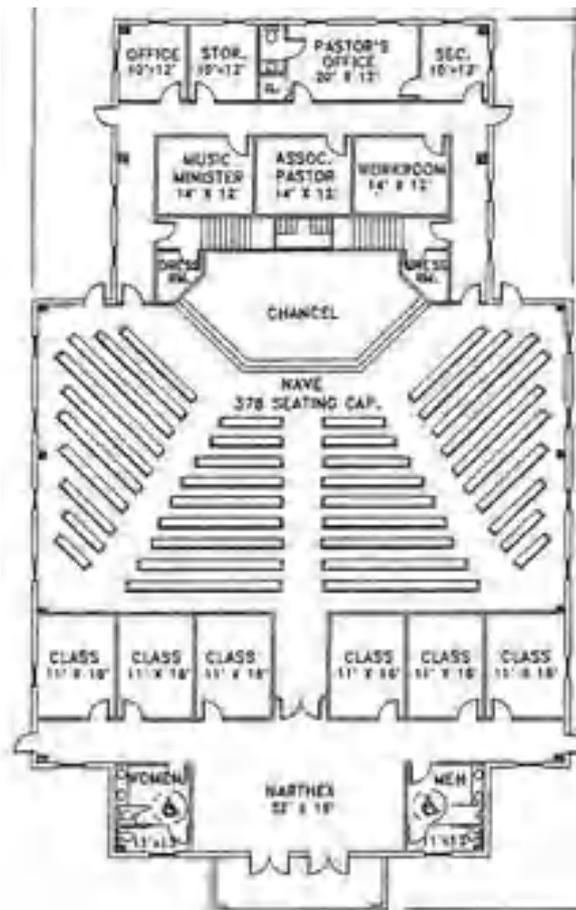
Planta baixa padrão de uma igreja protestante no século XIX.
